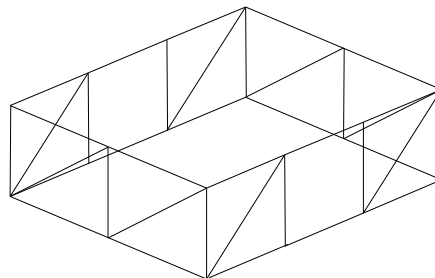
Plan schématique de modélisation de rez-de-chaussée et 1^{er} étage
